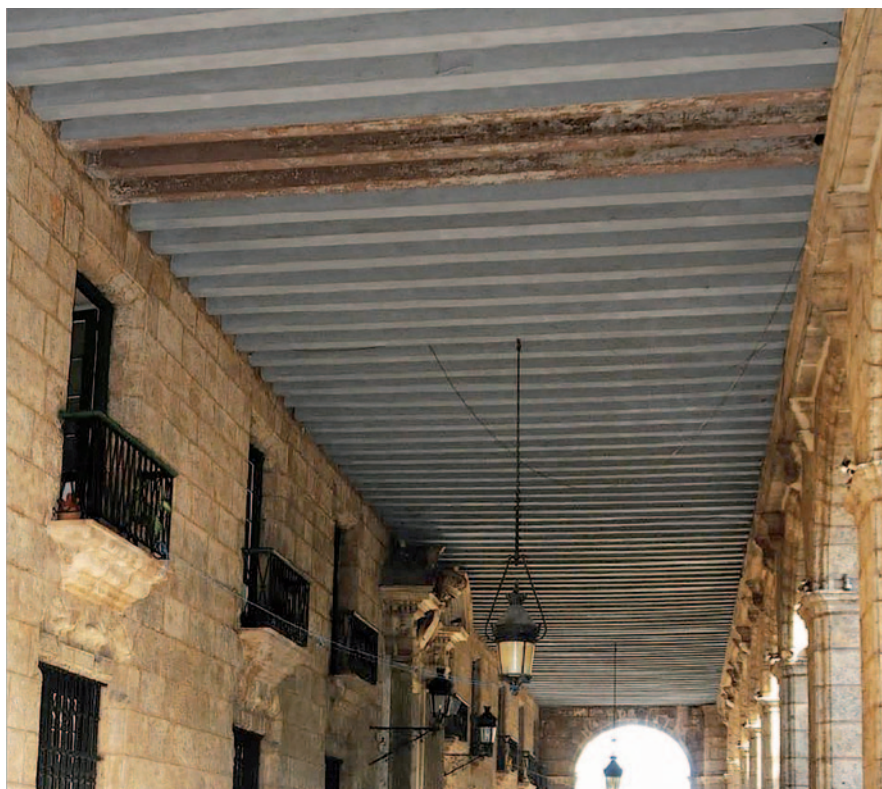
Techo con viguetería de cedro. Fotografía: Alina Cuza.
